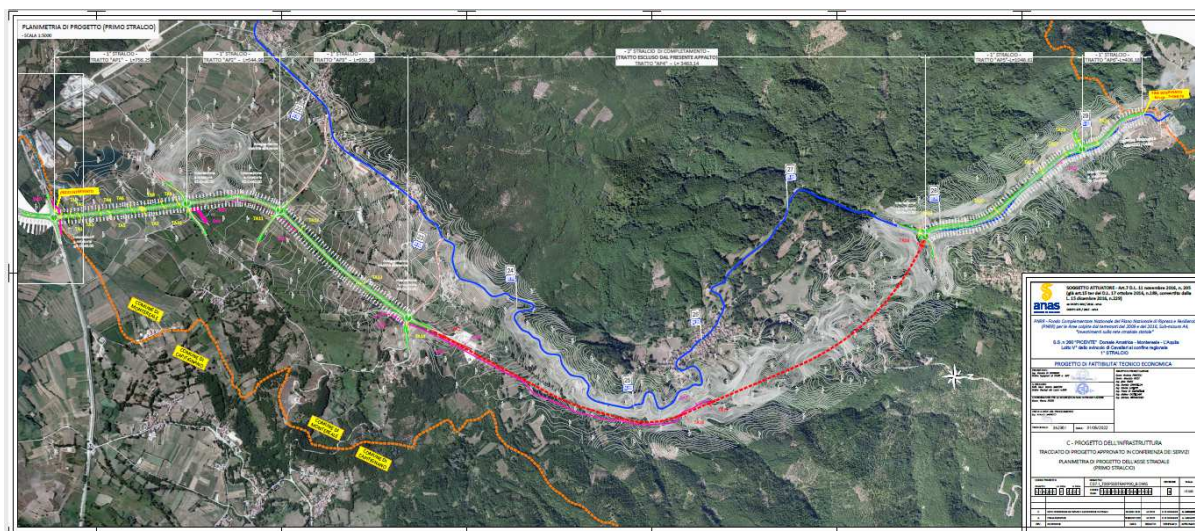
Planimetria su ortofoto di progetto dell'asse stradale (in blu ss260 attuale , in verde primo stralcio oggetto della presente procedura, in rosso secondo stralcio oggetto di separata procedura di VIA)
